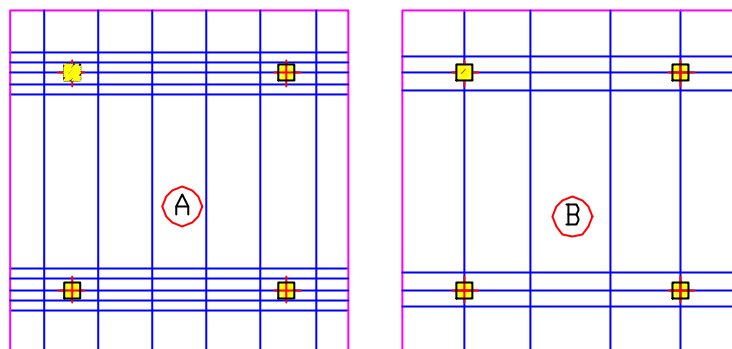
Lajes Unidirecionais + Vigas (Vigas Chatas Ou Convencionais)
